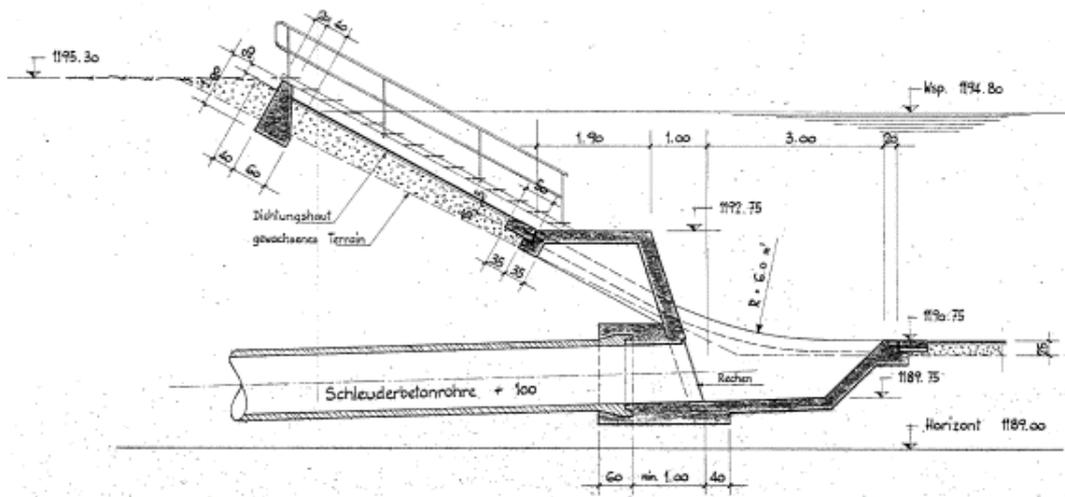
Schnitt durch die bestehende Seewasserfassung (Ausschnitt Plan Nr. 500-123).
